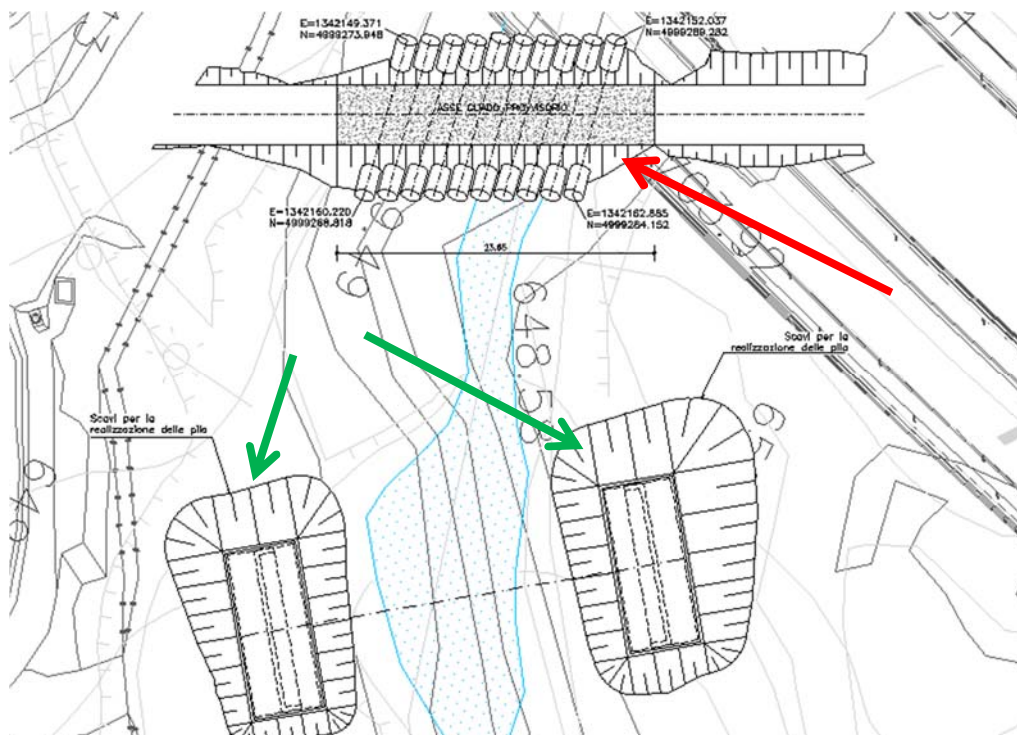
Guado provvisorio indicato con freccia rossa. Con freccia verde sono indicati gli scavi per la realizzazione delle spalle del Ponte Bailey
